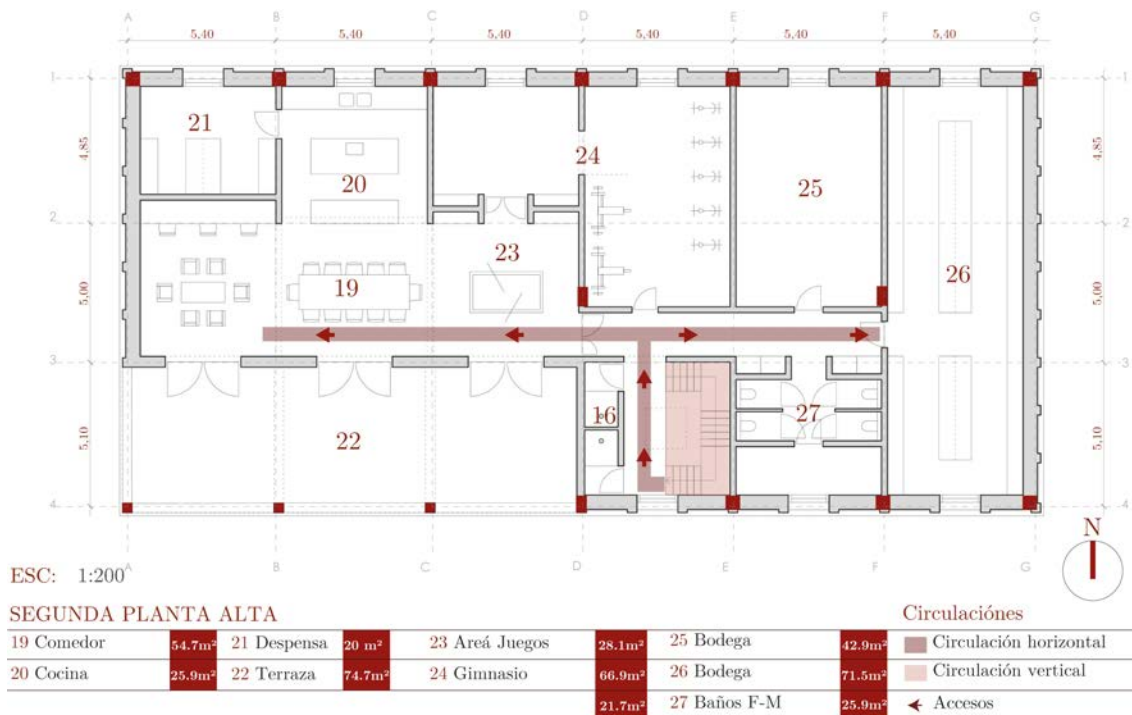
Segunda planta alta de la Estación de Bomberos Wilrijk, Amberes. Elaboración: Propia.
